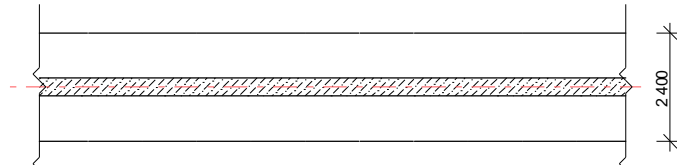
Фрагмент плану суцільного стрічкового монолітного фундаменту (1 варіант) по осі Д
